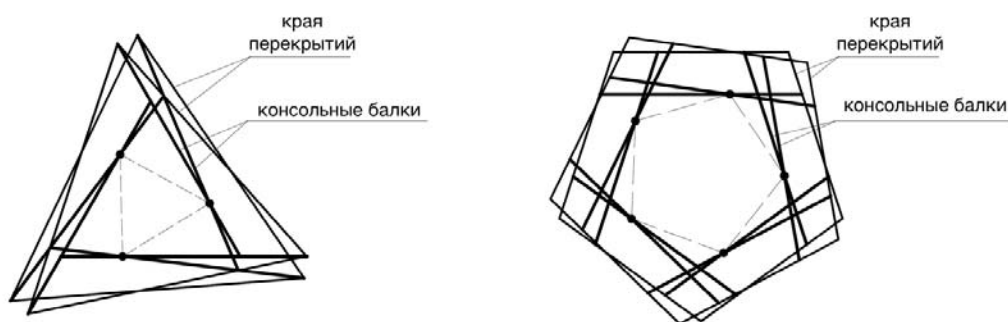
опорные плиты перекрытия с использованием систем консольных балок.
